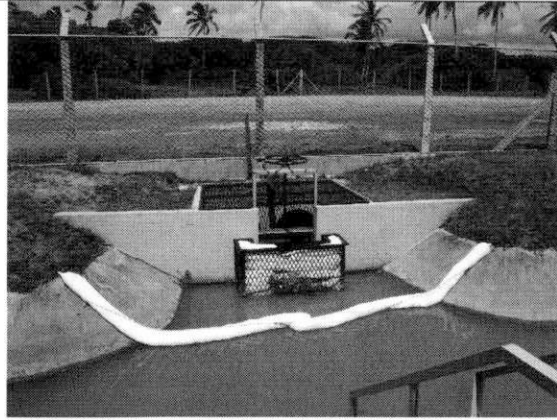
Tubulação de águas pluviais com o filtro para contenção de óleo.
